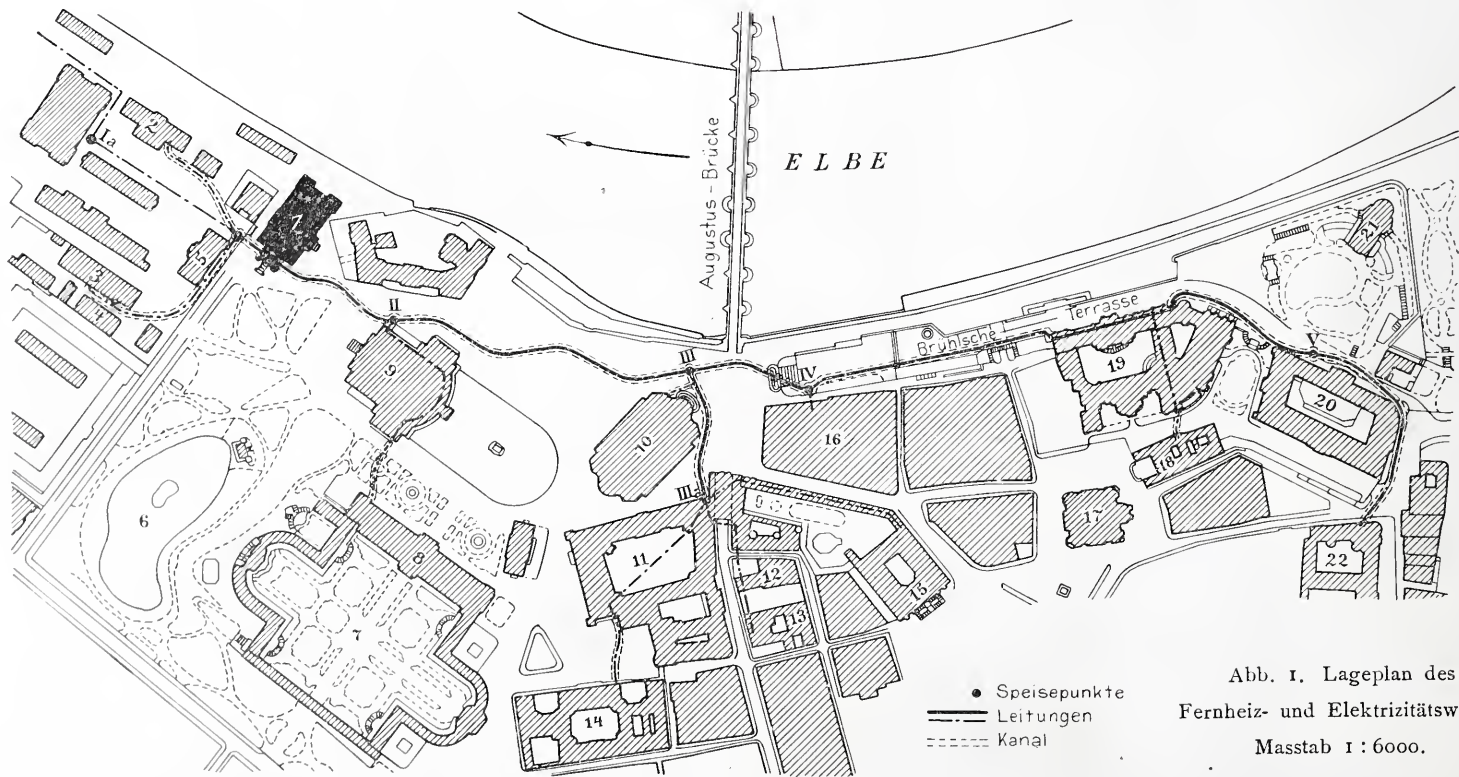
Lageplan des Fernheiz- und Elektrizitätswerks. Masstab 1 : 6000.
